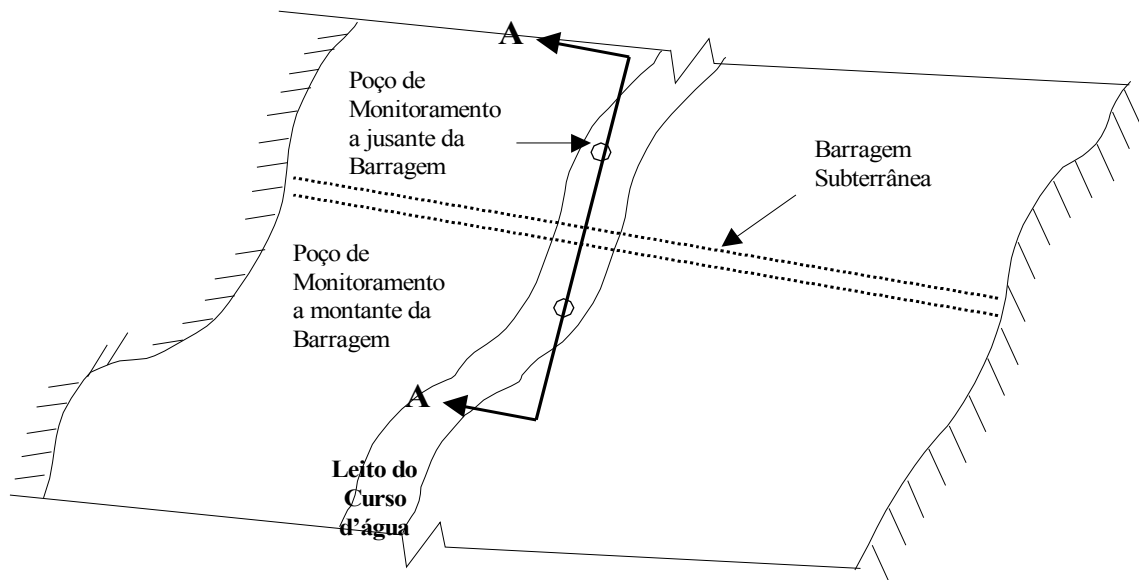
Esquematização, em planta, de uma barragem subterrânea.
